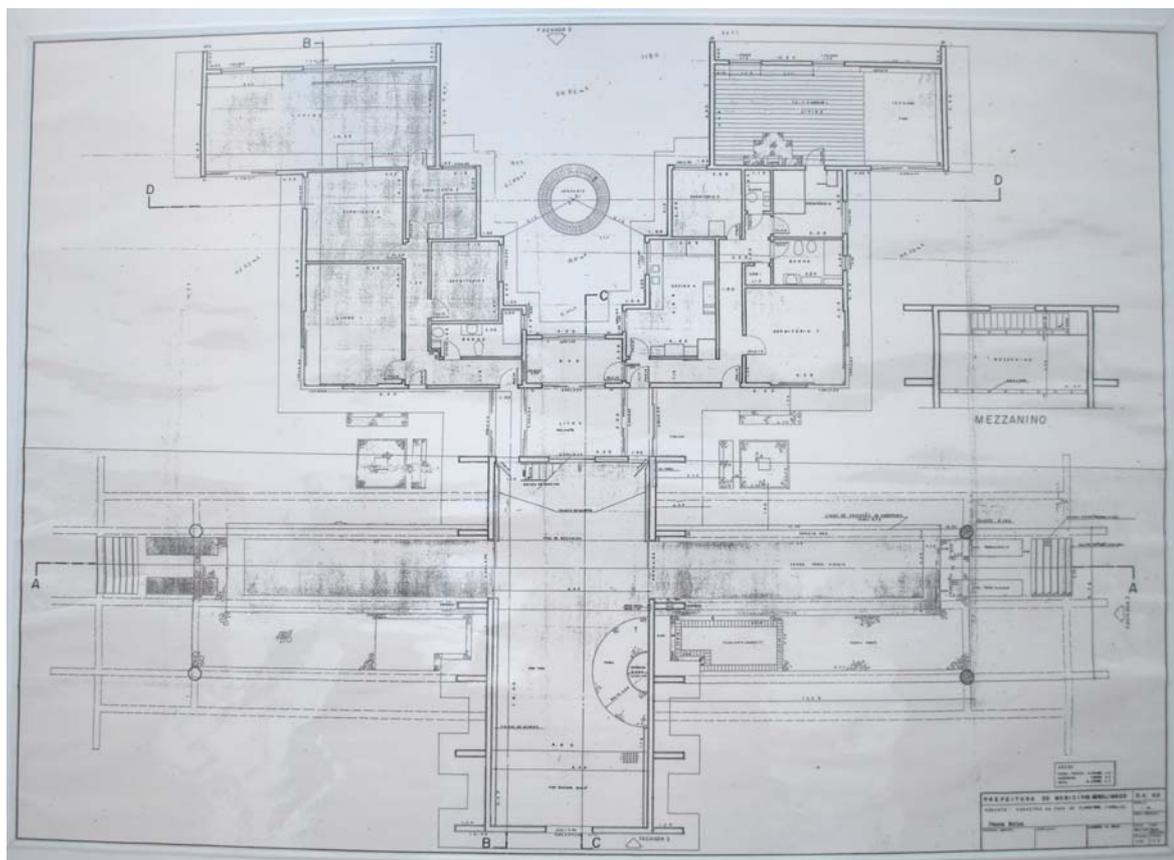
Fotografia: Planta Baixa da sede modernista. Fonte: Prefeitura de Valinhos, 1993. Foto do pesquisador.
